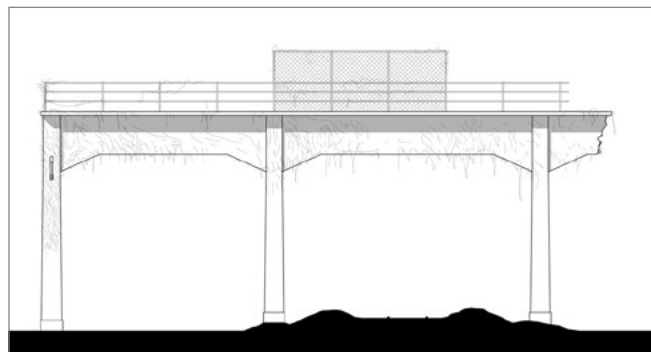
Prospetto sud del rudere di cavalcavia a Trofarello (elaborazione di Cristiano Tosco).
